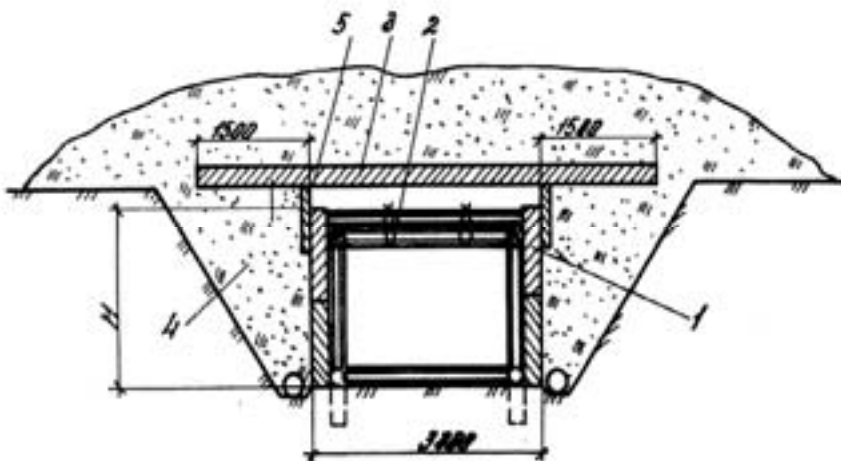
Сховища з податливим покриттям: 1 – панелі стін; 2 – покриття з колод; 3 – залізобетонна плита; 4 – насипний ґрунт; 5 – вертикальний елемент.
